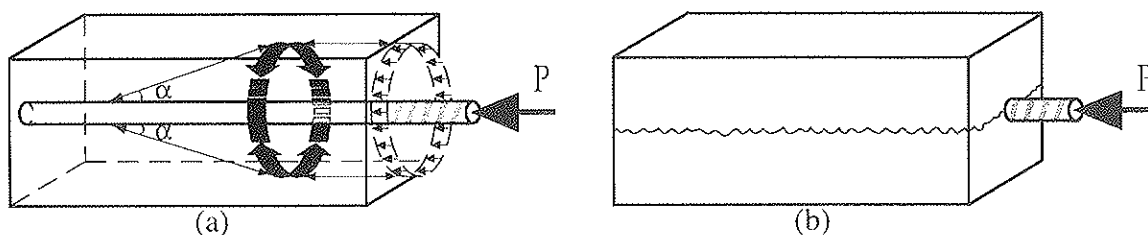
Fenómeno de agrietamiento longitudinal de las piezas de hormigón pretensado al realizar la transferencia del pretensado: (a) anillo de tracción [9]; (b) fisuración longitudinal.
